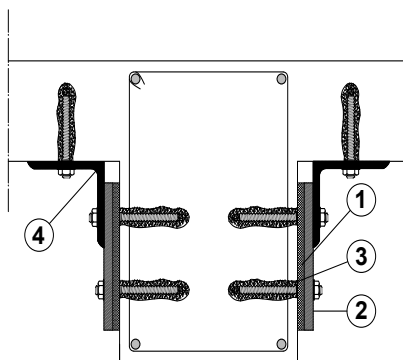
Tipologia 7: representação da secção transversal da viga reforçada. Legenda: 1 – resina epóxi; 2 – chapa metálica; 3 – bucha metálica.
